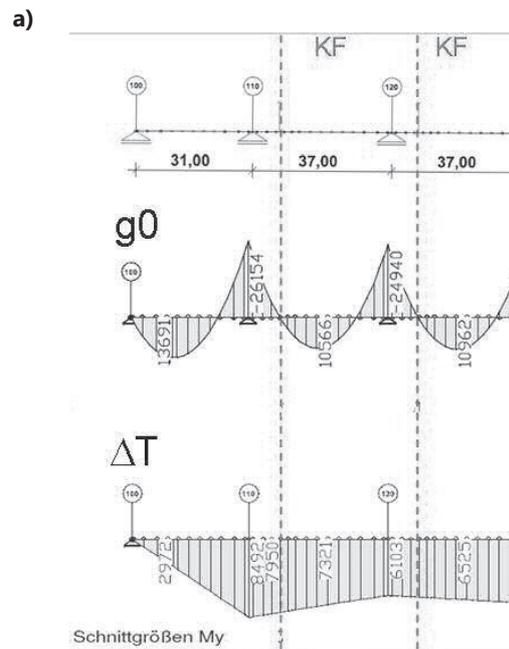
a) Spannbetonhohlkastenbrücke als Durchlaufträger (Baujahr 1973, Brkl. 60 nach DIN 1072, mit Angabe von der Koppelfugen (KF) und Schnittgrößen aus Eigengewicht und Temperatur)
